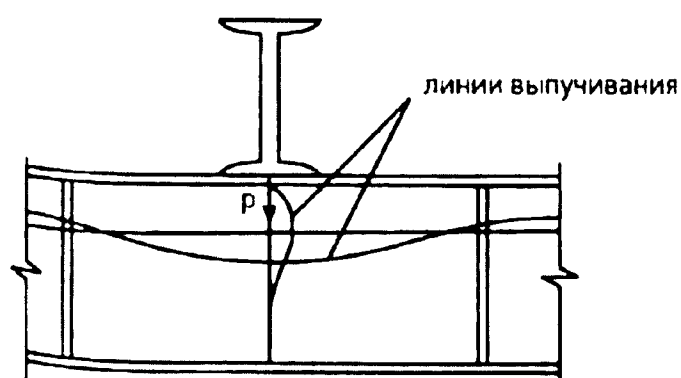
Опирание балки из прокатного профиля на балку составного сечения
